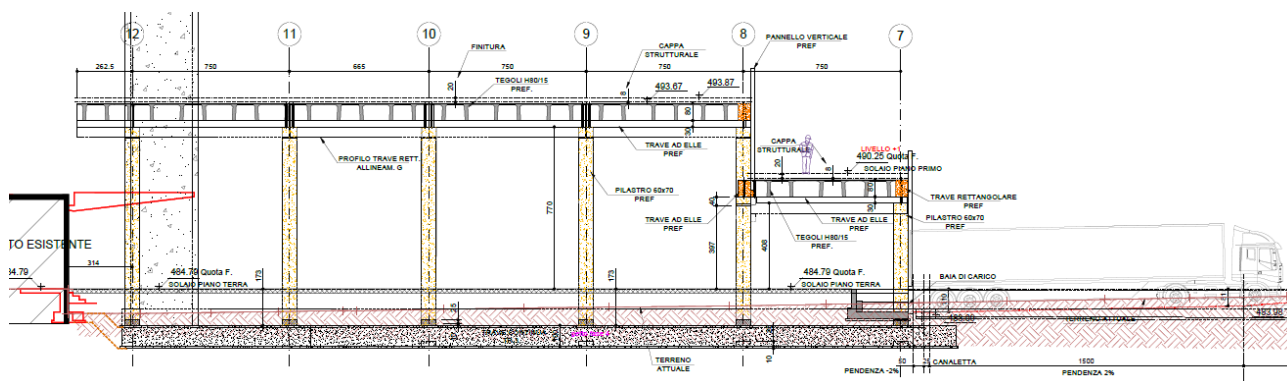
Sezione longitudinale E-E – Nuovo magazzino spedizioni
